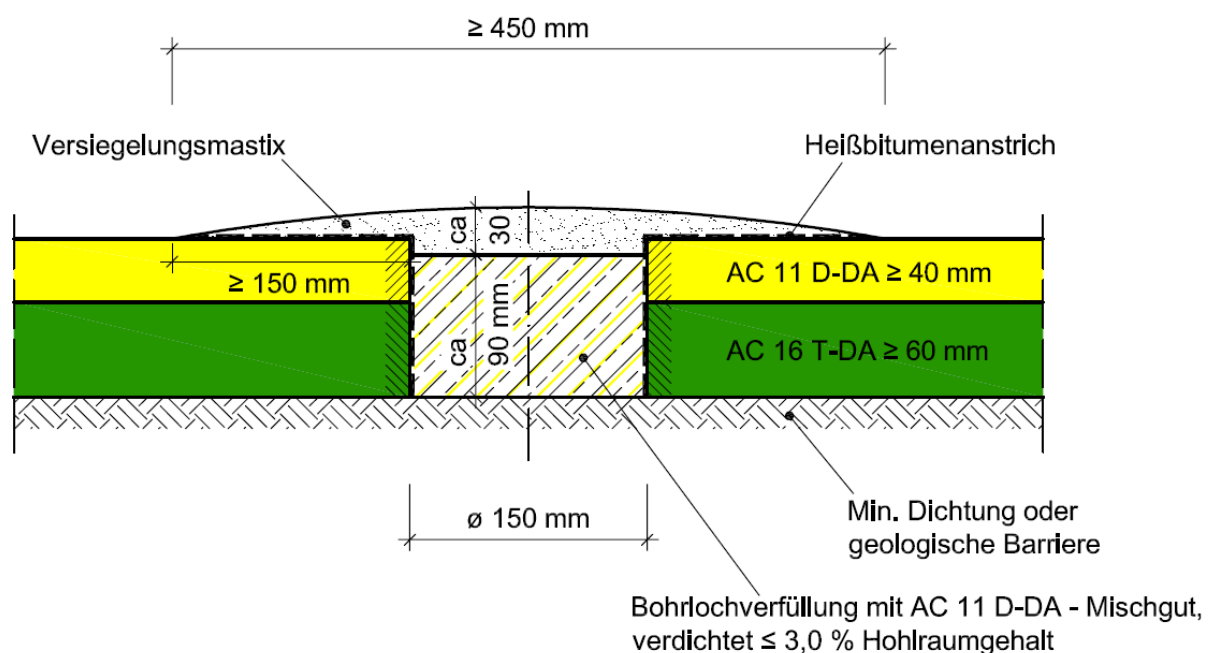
Skizze Bohrkernentnahme und Verschließen Bohrloch für Variante A
